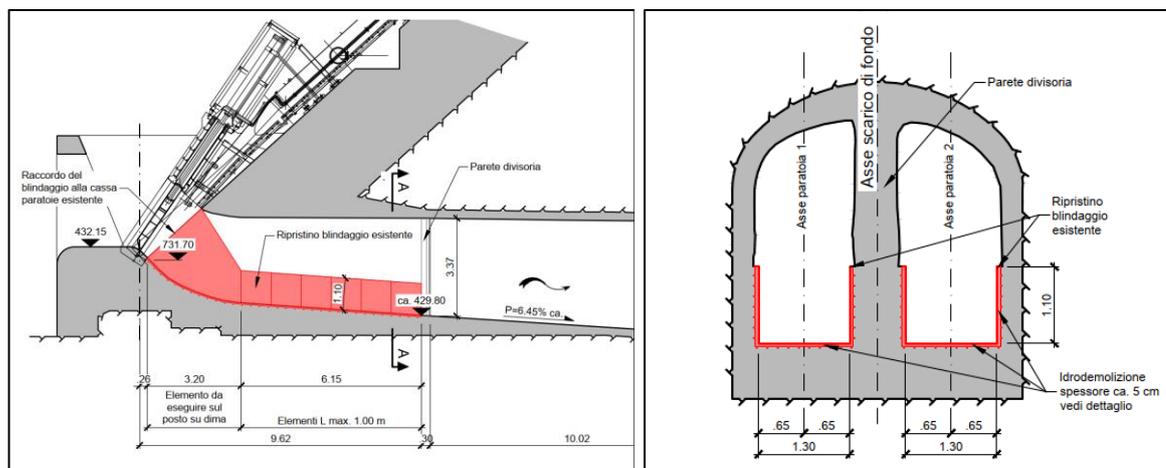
Sezione longitudinale e trasversale dello scarico di fondo, subito a valle delle paratoie, con indicazione del blindaggio da ripristinare in rosso
